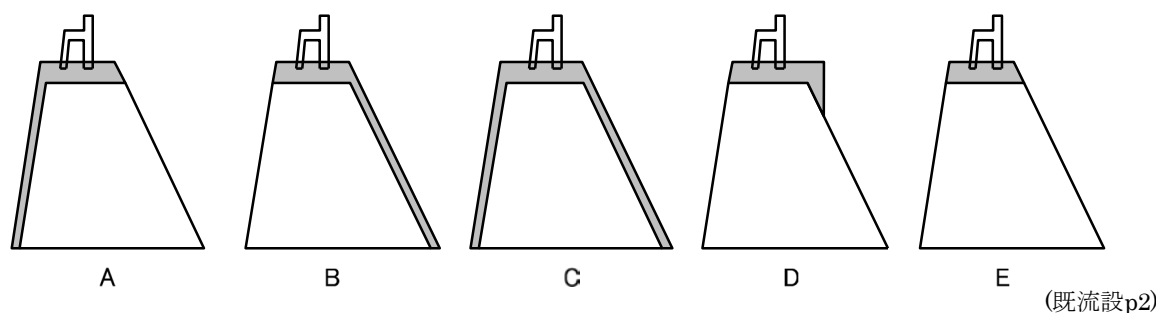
基礎コンクリートおよび補強コンクリートの打設
